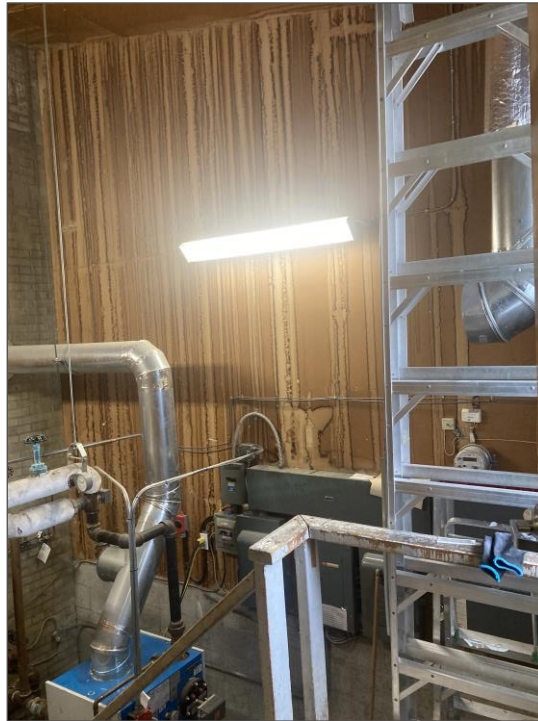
Coullisse d'eau sur le mur, local de la fournaise
